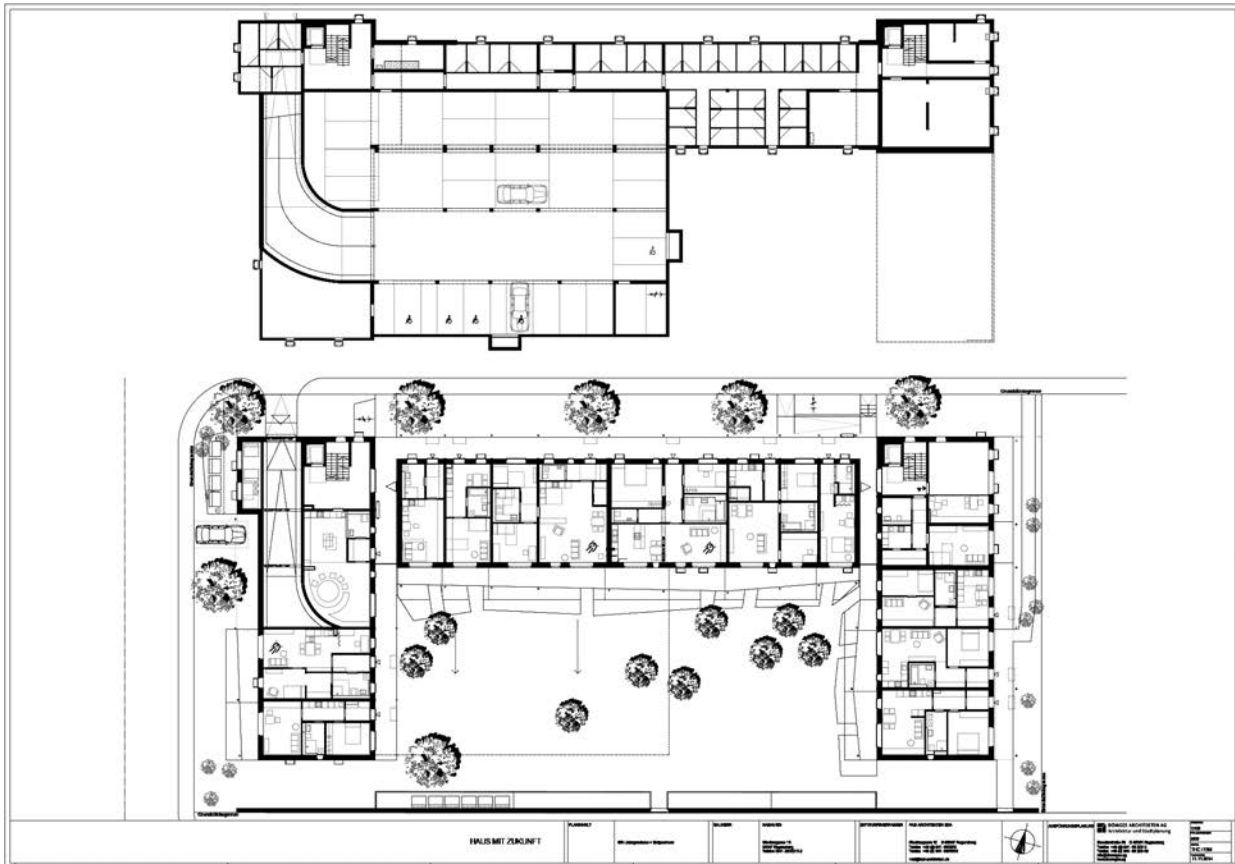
Grundrisse Untergeschoss und Erdgeschoss
